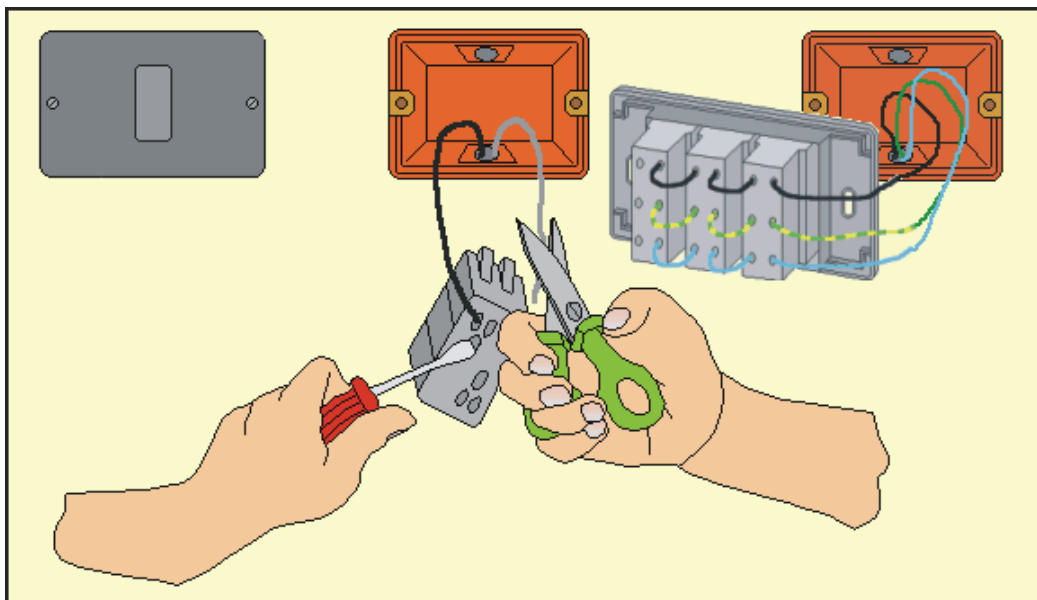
Collegamento e montaggio degli apparecchi sui supporti e fissaggio della placca di finitura
